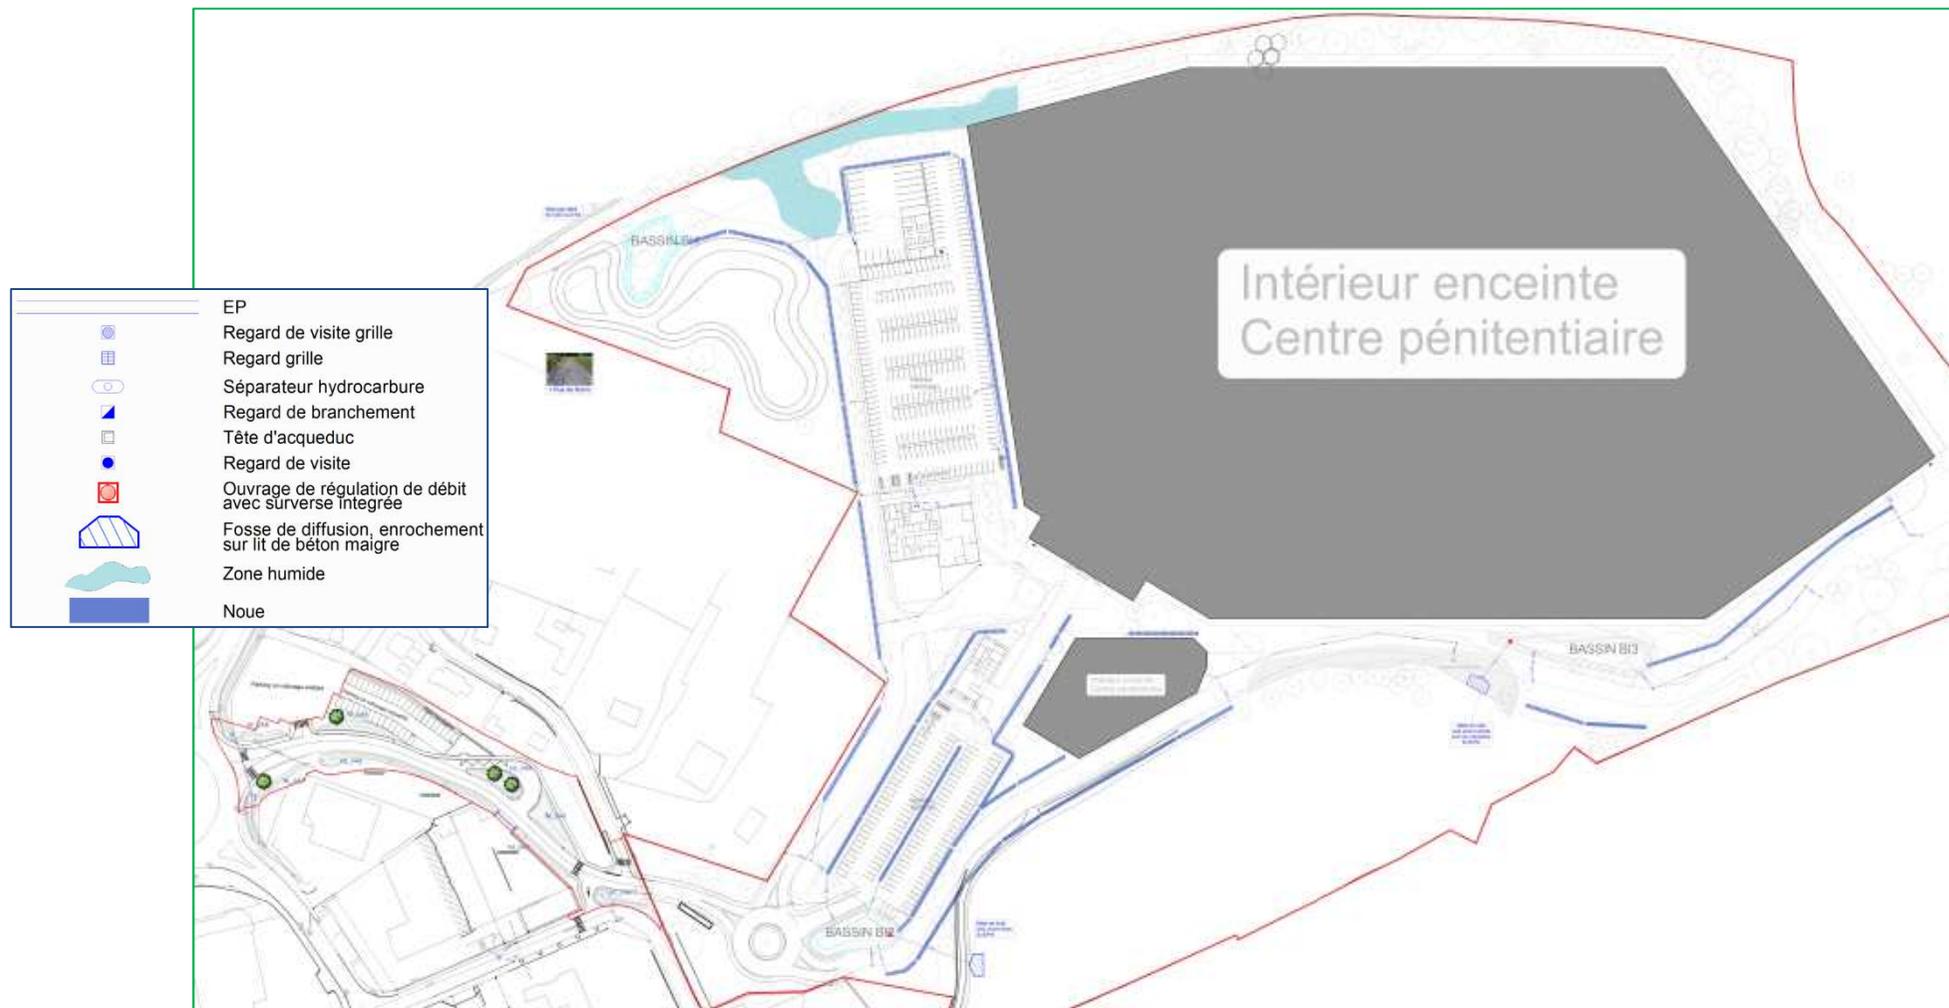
Plan de gestion des eaux pluviales (Source : B4 Design & Engineering, février 2025)
